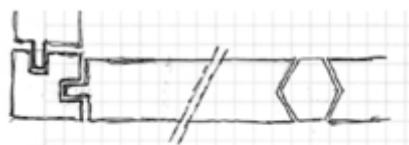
Byggnadens inre konstruktion. Dessa stolpar och den längsgående bärlinan är alla handhyvlade och till stor del fasade.
